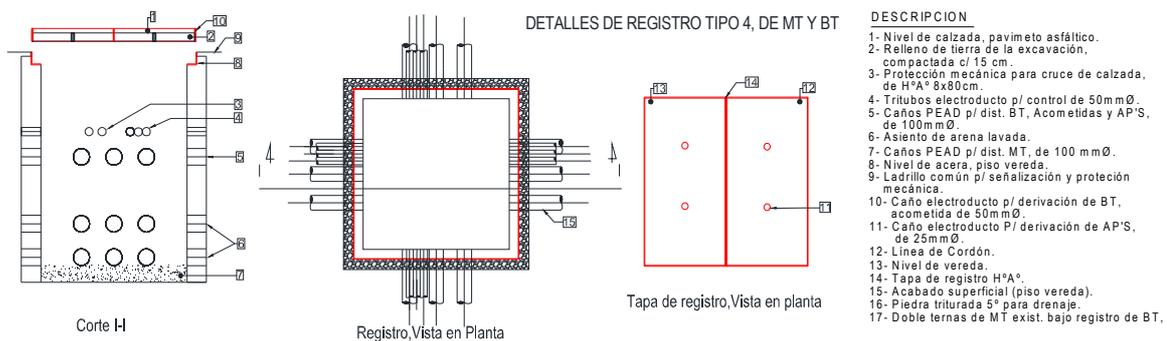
Registro Tipo 4 a) En corte b) En Planta c) Tapa de registro
